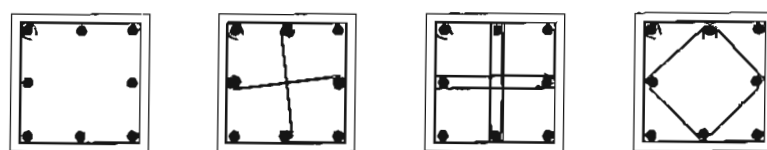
Arranjos de estribos para pilares com armaduras nas quatro faces.
